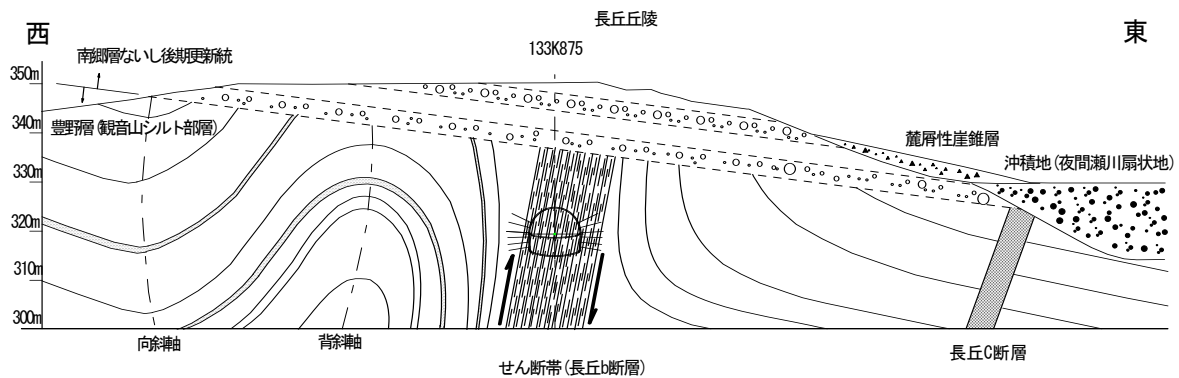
せん断帯を含む地質断面図 (図 5-5 A-A' 断面)
